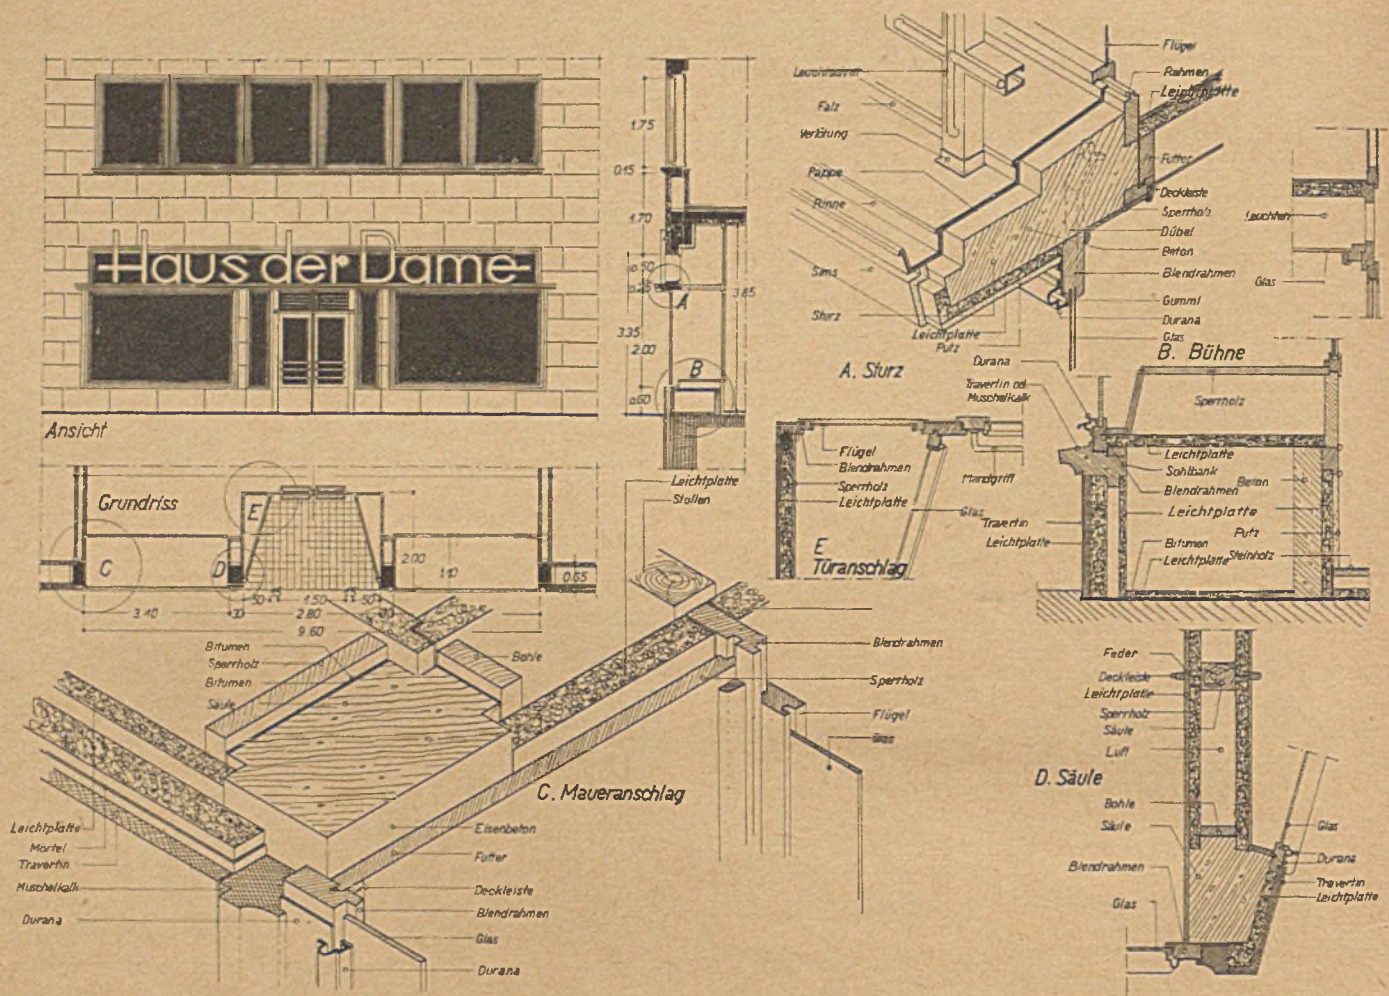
¹⁾ bringt die werbende Kraft der Schaufensteranlage zur Geltung. Sie beweist, daß man durch einfache Gliederung in Verbindung mit Schrift und Hausfront den Laden durchaus nicht als Einzelteil zu empfinden braucht. So begeistert die Schauseite nicht nur ihrer vollkommen übersichtlichen Anordnung wegen, sie bietet auch in der Ausführung durch ihre Sauberkeit einen besonderen Reiz, den die Travertinplatten einer Werbefront verleihen.
